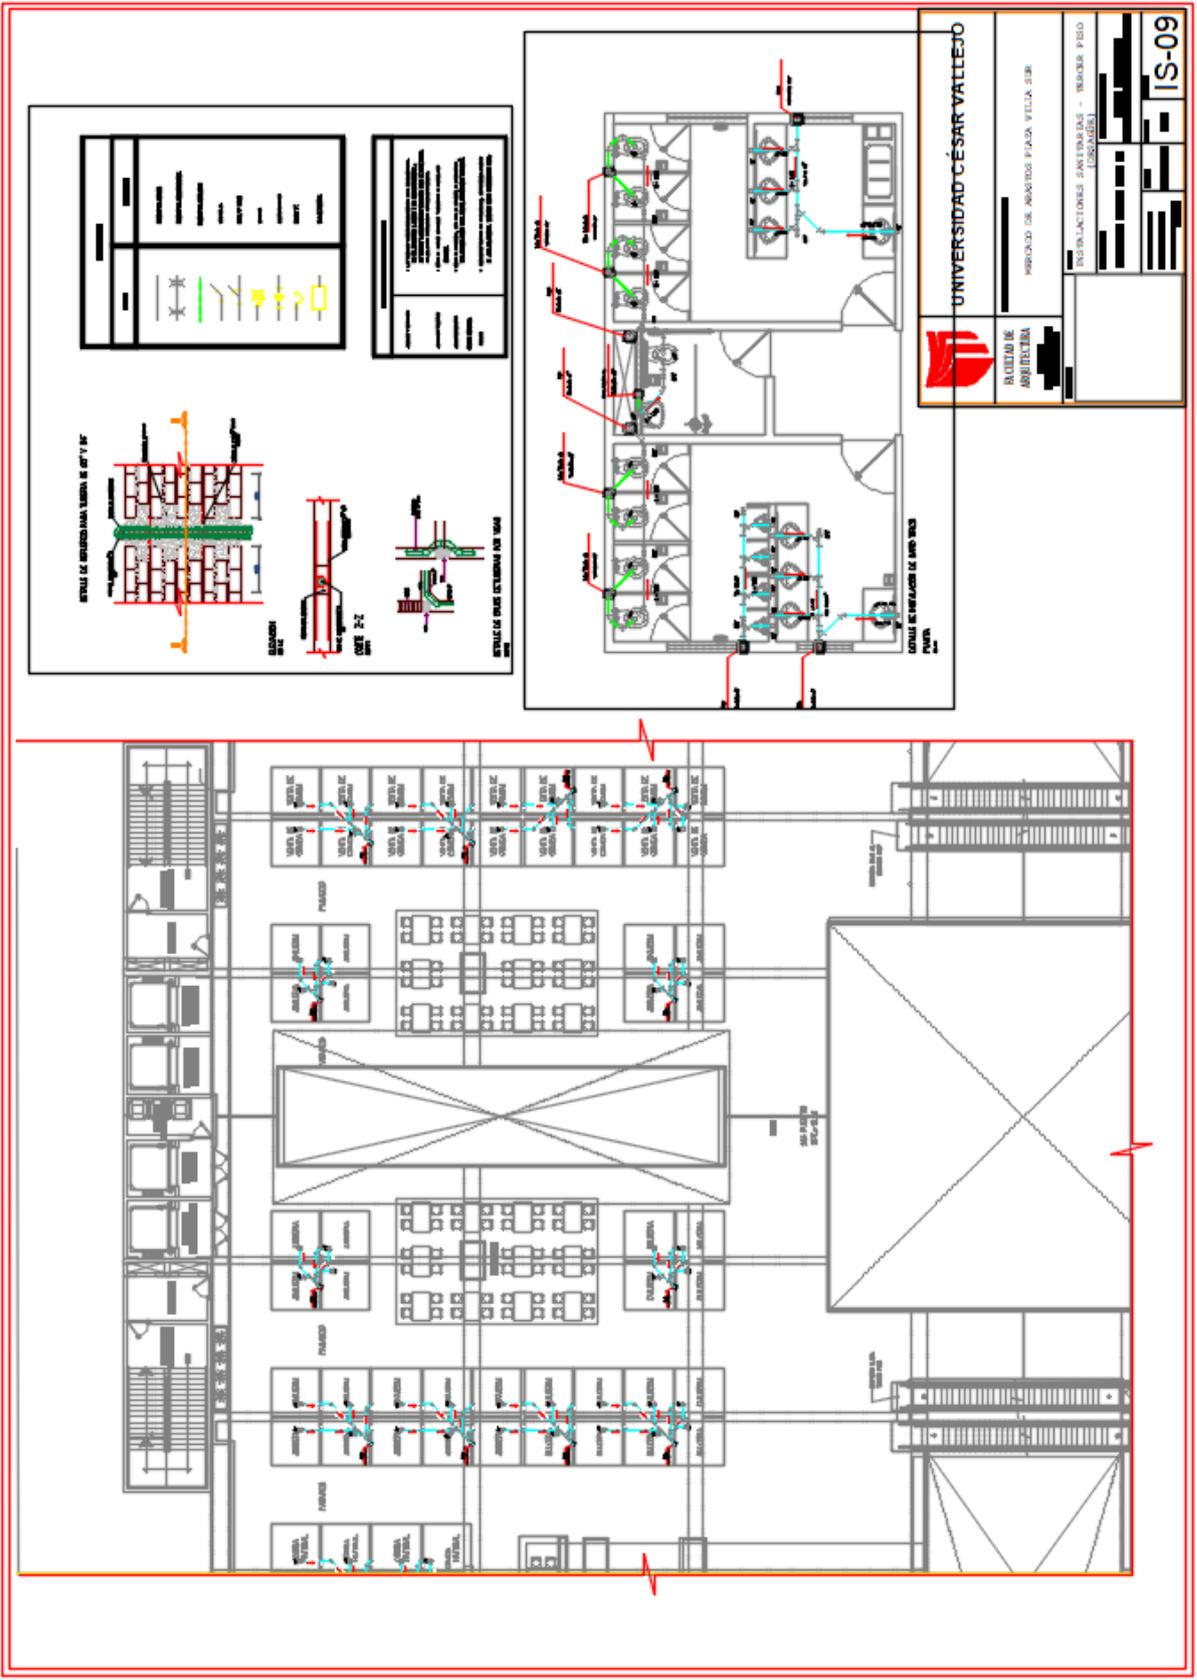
Plano de Sanitarias – Plano de instalaciones de desagüe – tercer piso
